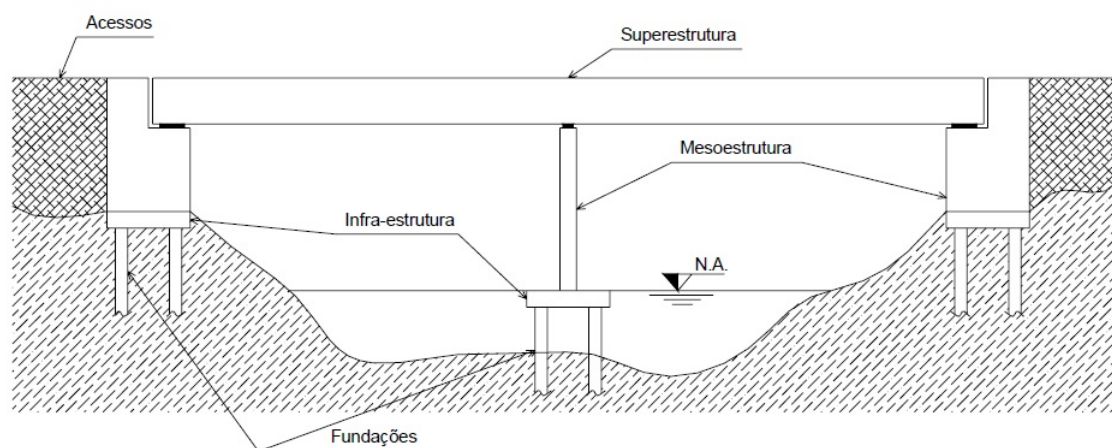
Elementos Constituintes de pontes (Adaptado de Manson (1977))
